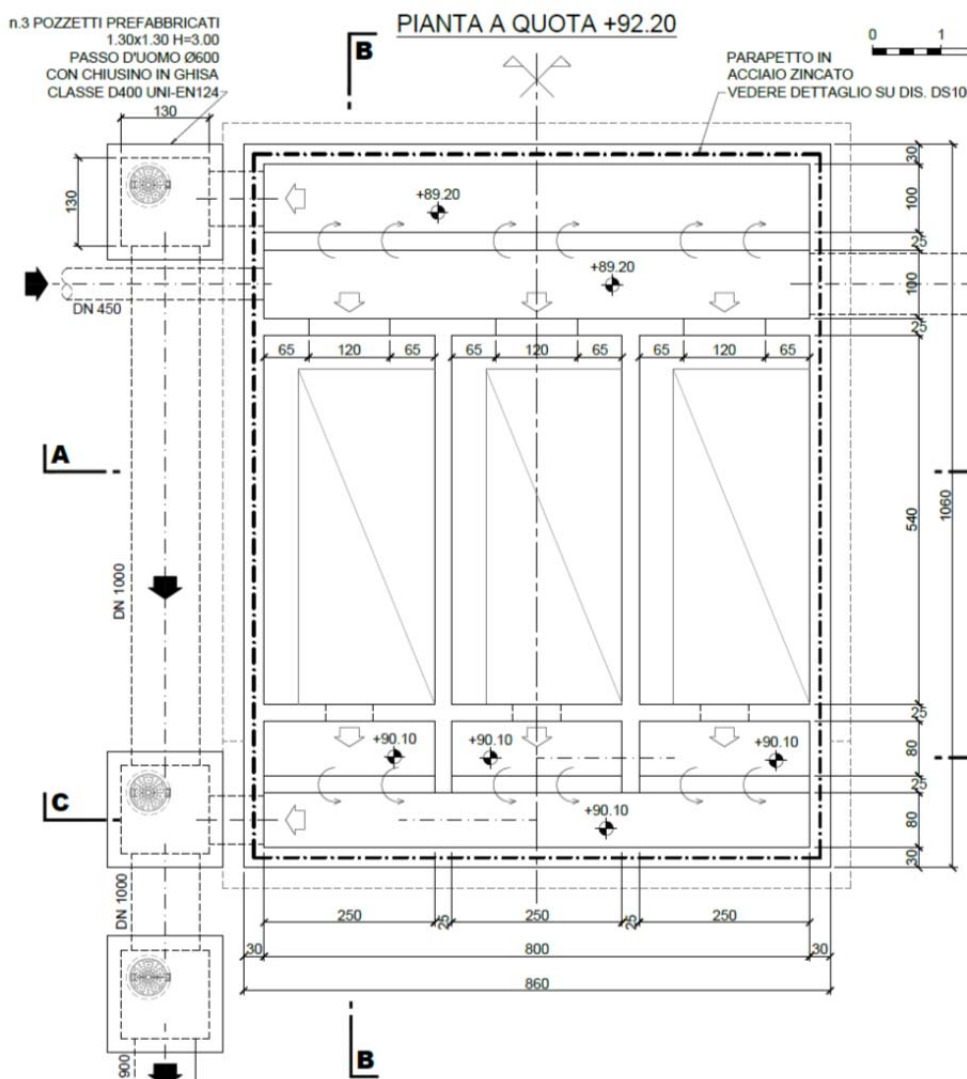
FILTRAZIONE FINALE – PIANTA
